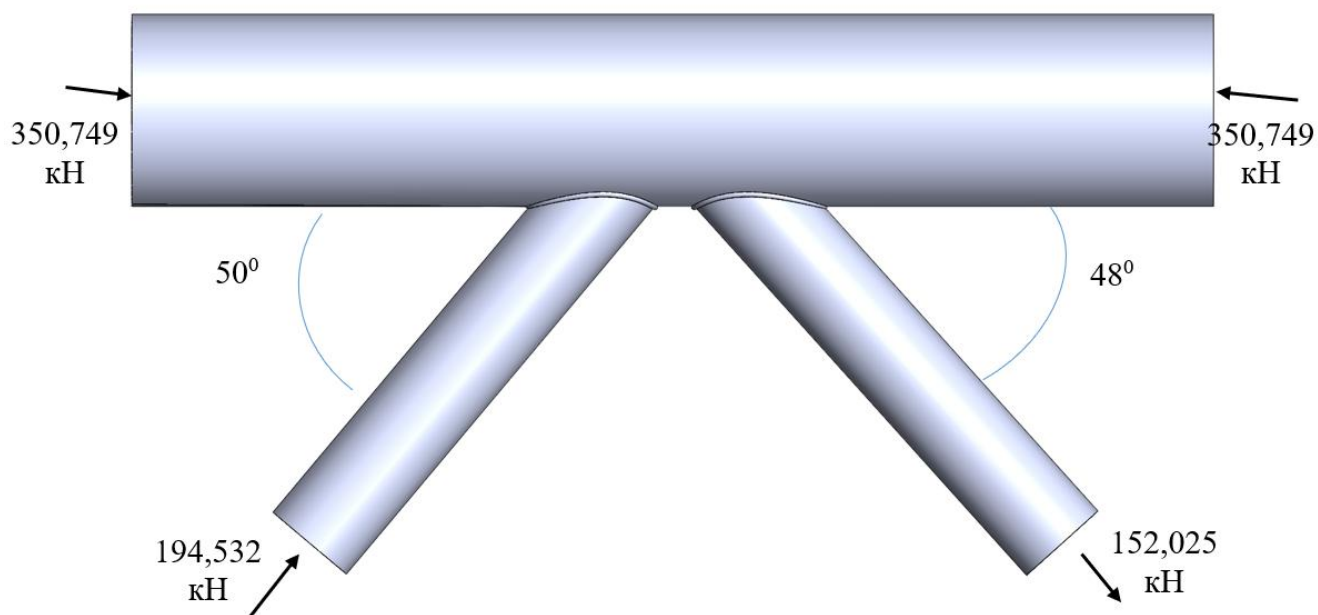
Загальний вигляд зварного вузла верхнього пояса ферми
